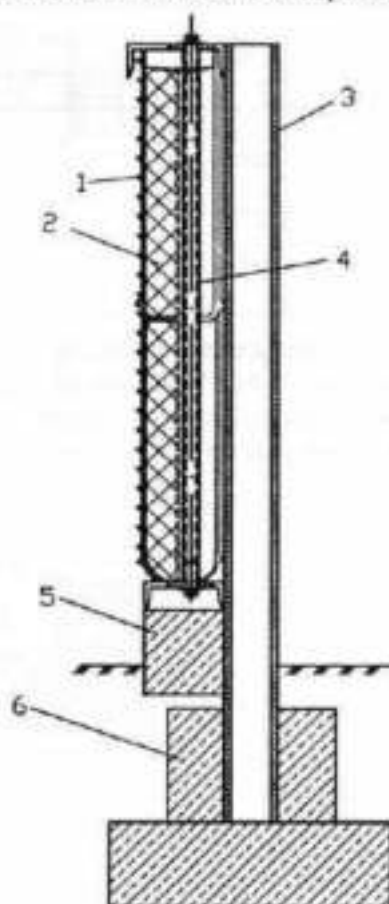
Конструктивний розріз шумопоглинаючого металевих екрану:
